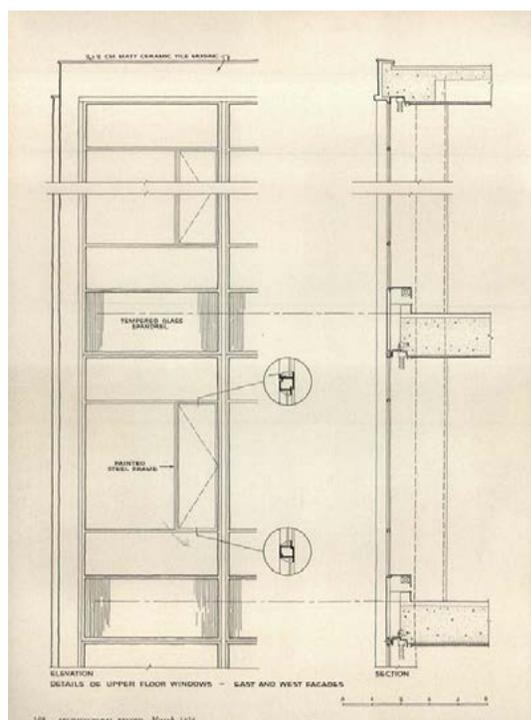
Detalle Spandrelite en fachada. Revista Architectural Record, p. 168, 1958,
